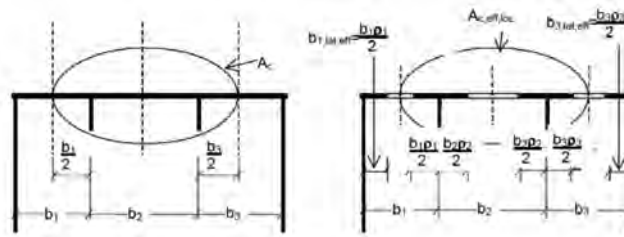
Lastra irrigidita uniformemente compressa
